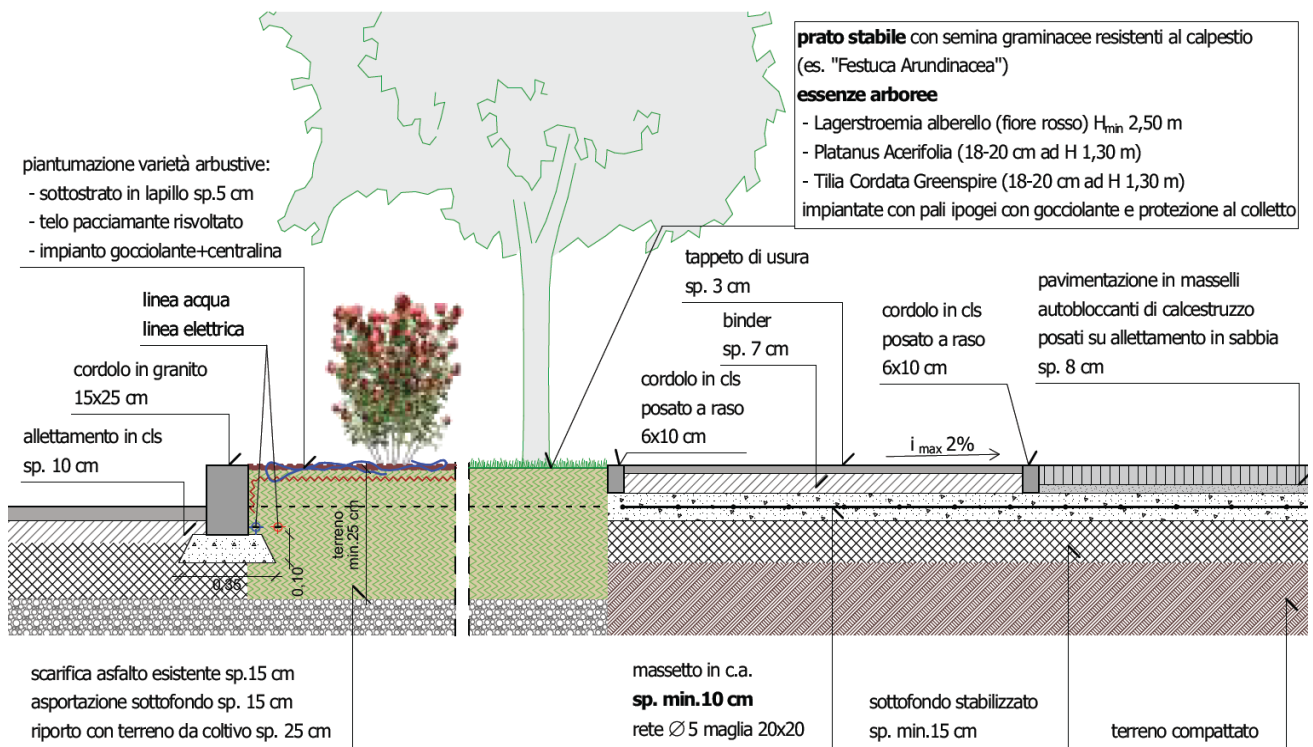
Estratto Tav. 6.9 - Dettagli
